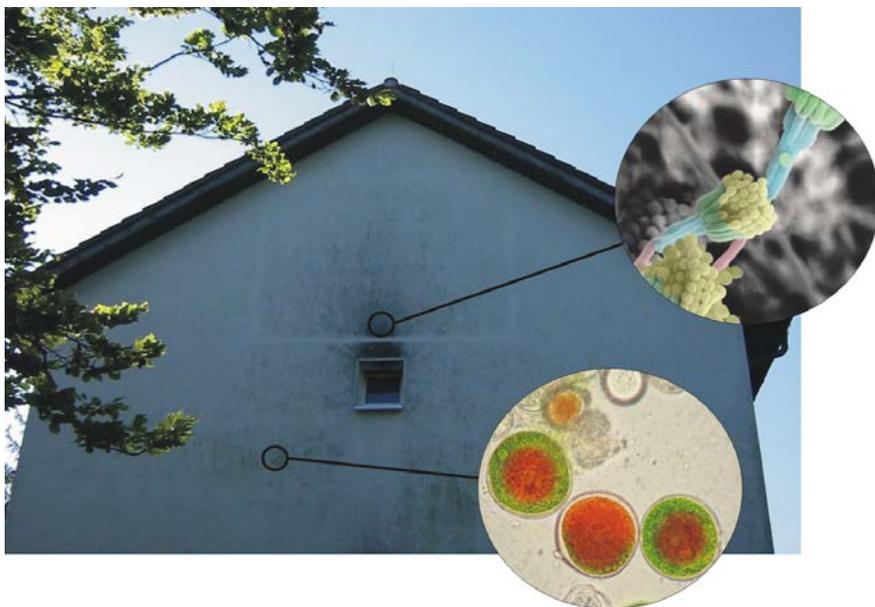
Algenbewuchs einer Fassade mit Wärmedämmverbundsystem und Schimmelpilzbewuchs oberhalb eines Fensters.
